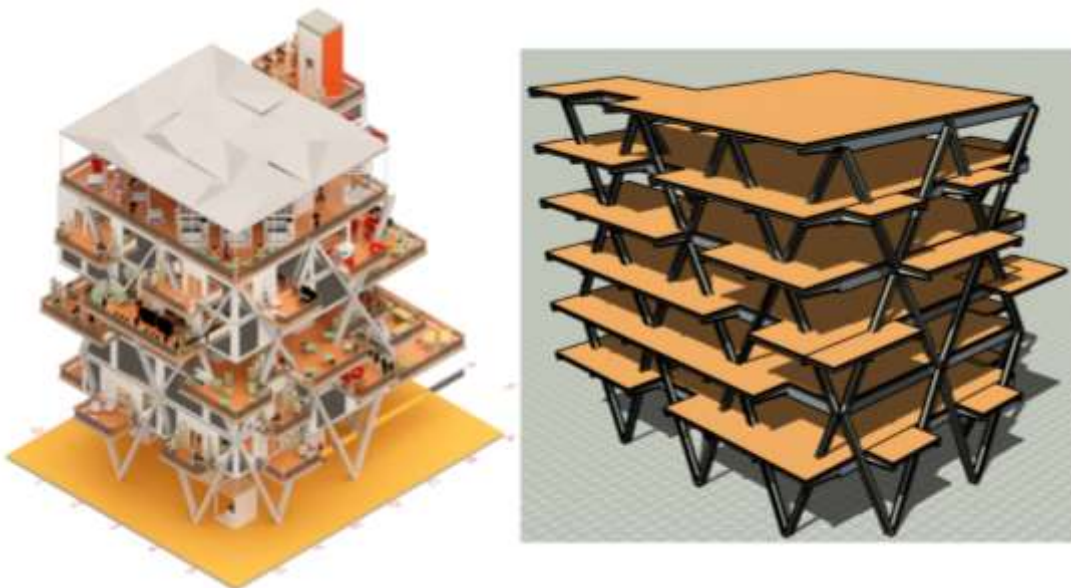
Propuesta 3d de agrupaciones de vivienda. Autoría propia (2020)
